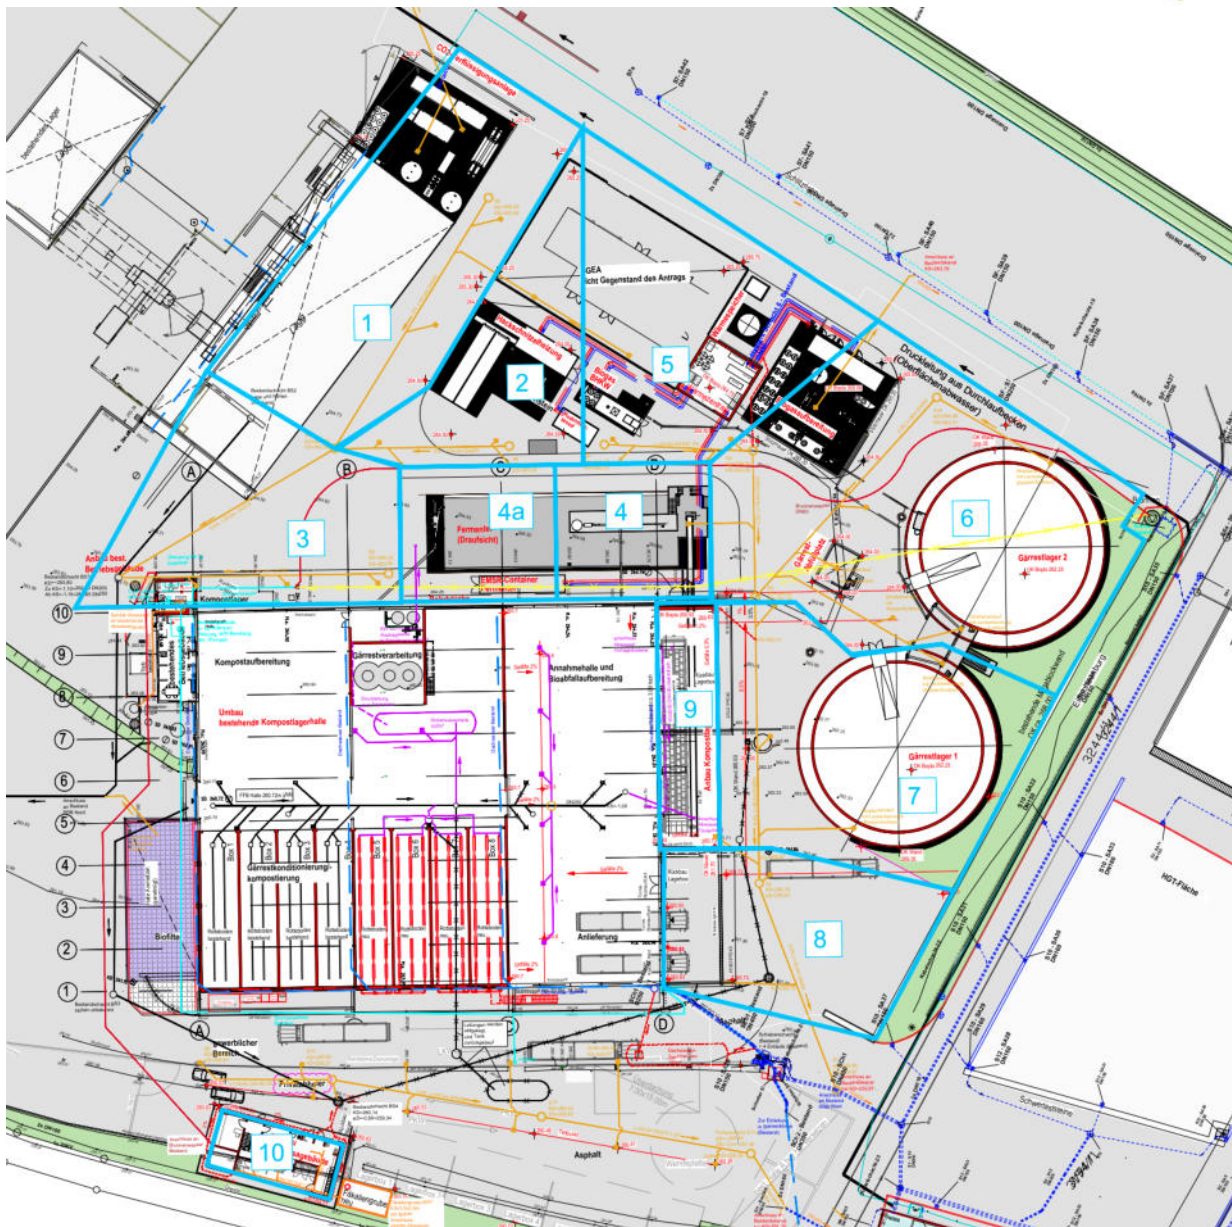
Lageplan (alter Stand) Entwässerung mit Entwässerungsflächen (1-10)
